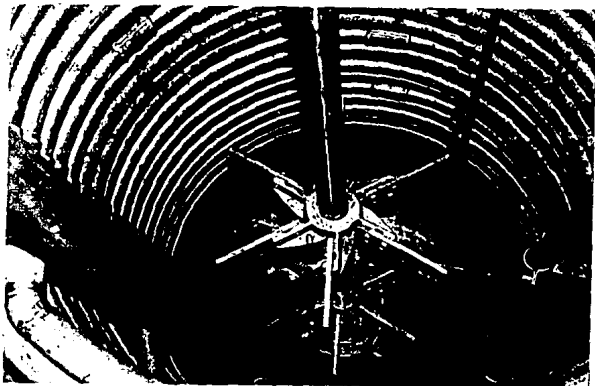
Obsérvese el mal acabado e irregular de la soldadura de los soportes.
